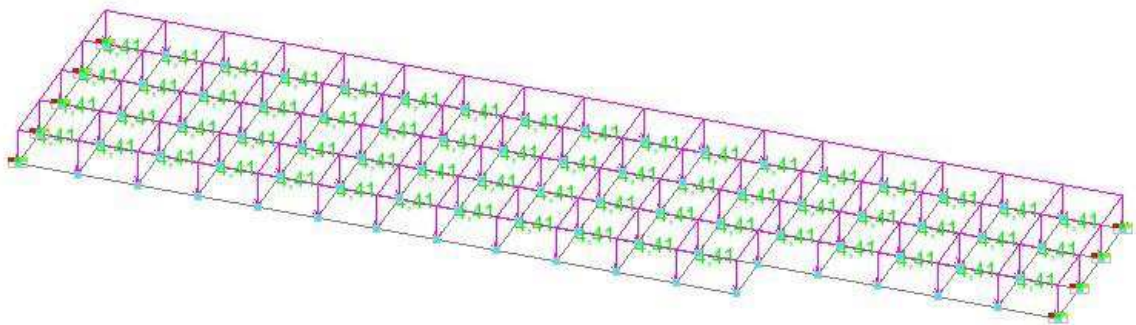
Схема загрузки плиты нагрузкой от собственного веса
